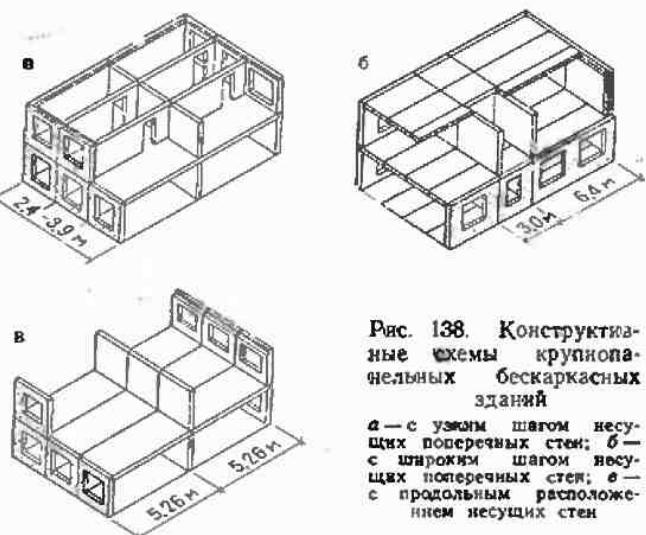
Конструктивные схемы крупнопанельных бескаркасных зданий
